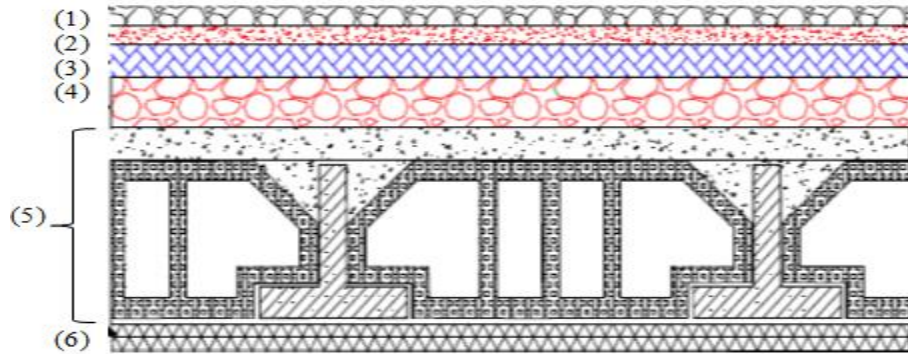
Coupe transversale du plancher terrasse à corps creux.
